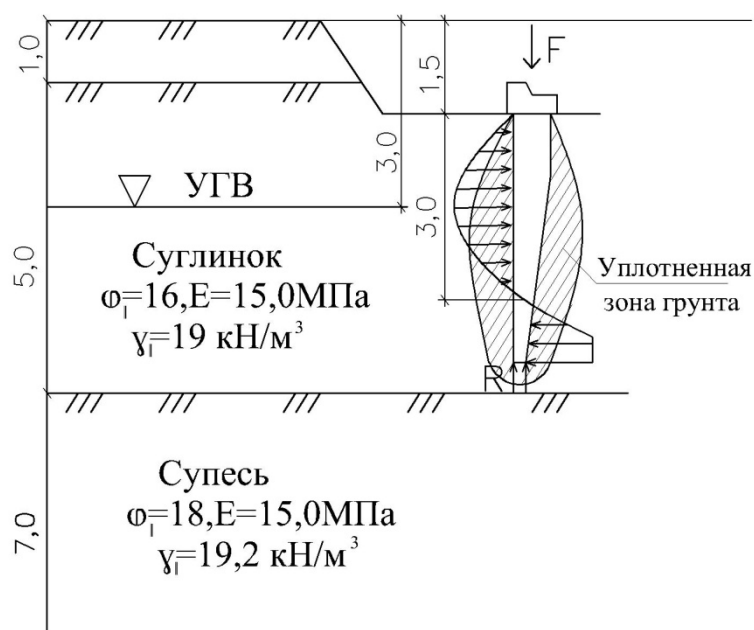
Коническая свая в пробитой скважине(эпюра давления грунта на свая, уплотненная зона грунта).
